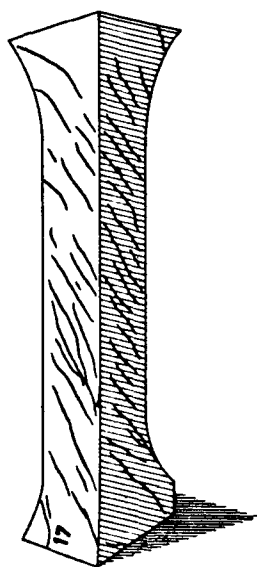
Probeta sometida a torsión, después de rebasado el momento máximo. Estaba armada con 8 fierros longitudinales y hélices. Cuaderno 16 de la Comisión Alemana para el Hormigón Armado. Citado por Morsch.²¹
